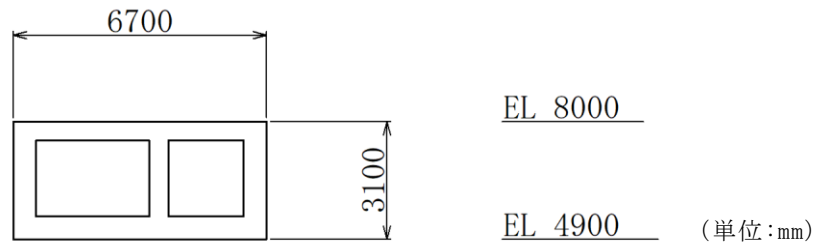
屋外配管ダクト (タービン建物～排気筒) 断面図 (A-A 断面)
